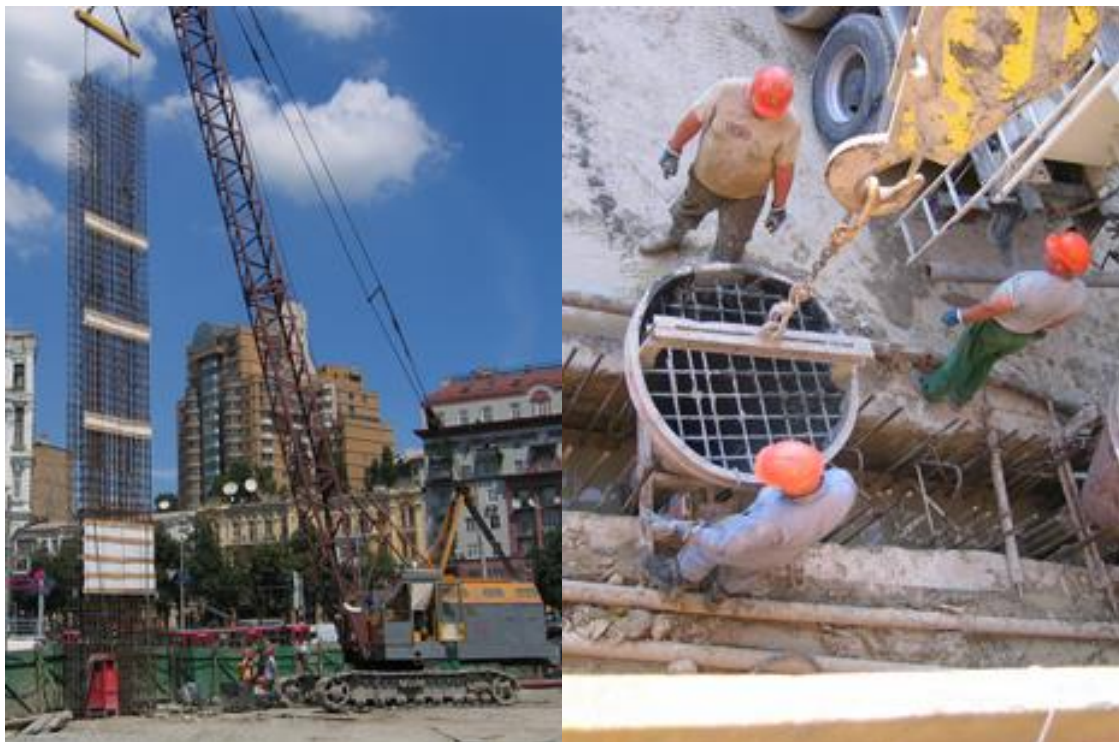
Армування та бетонування «стіни в ґрунті»
